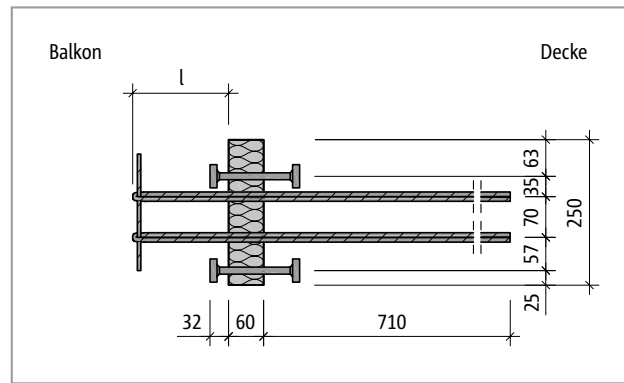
Schöck Isokorb® T Typ O-X60: Produktgrundriss
